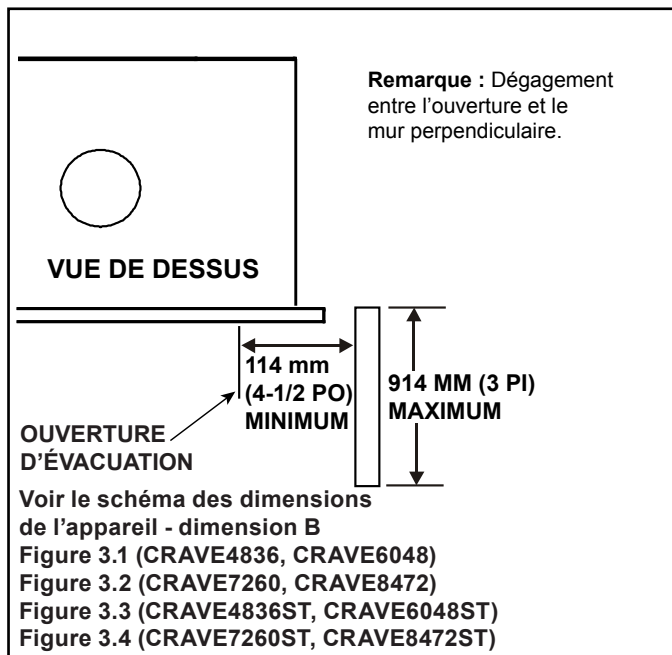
Pied du manteau de foyer ou saillies du mur
